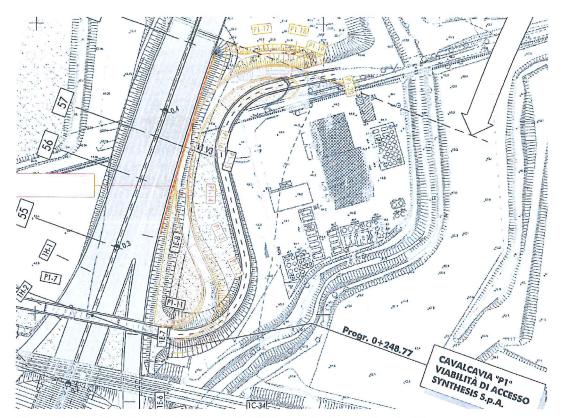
Estratto allegato lettera prot. 4665 – variante cavalcavia P1
